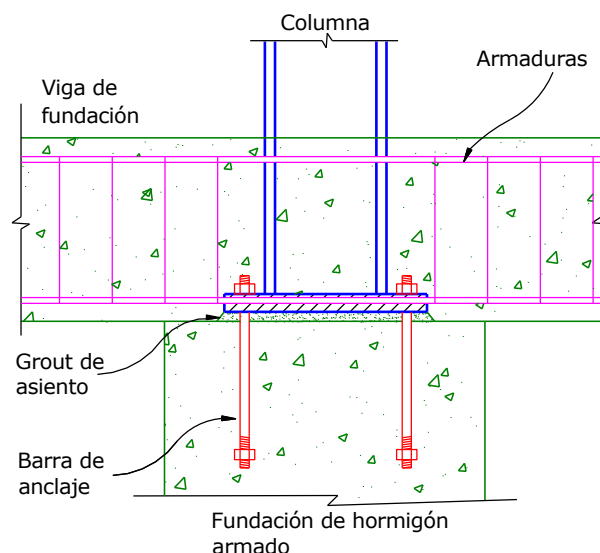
Ejemplo de base de columna embebida en una viga de fundación de hormigón armado.
